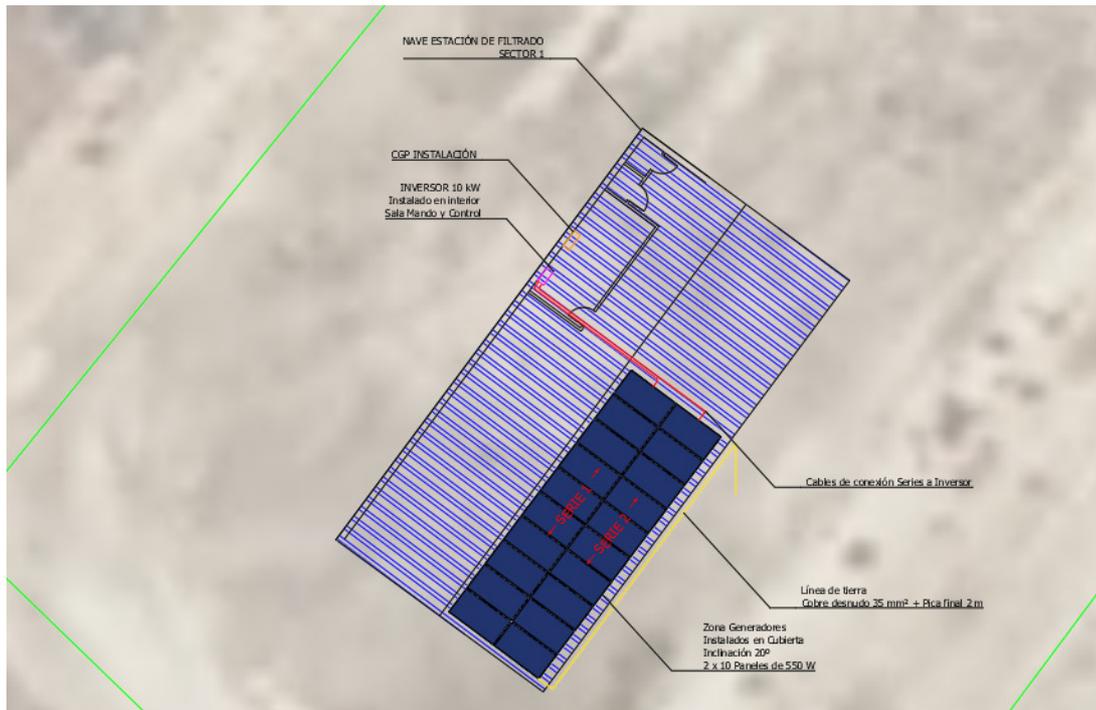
Planta general de la instalación fotovoltaica proyectada para la estación de filtrado
